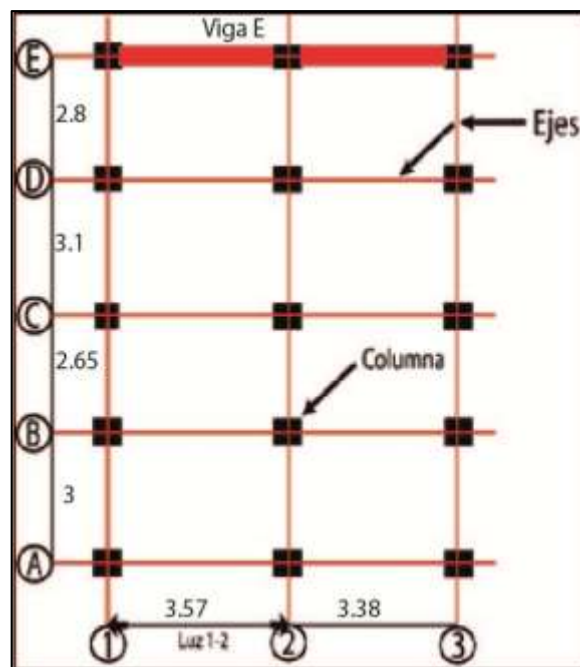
Vista planta de plano; Fuente: [Grupo investigador]
